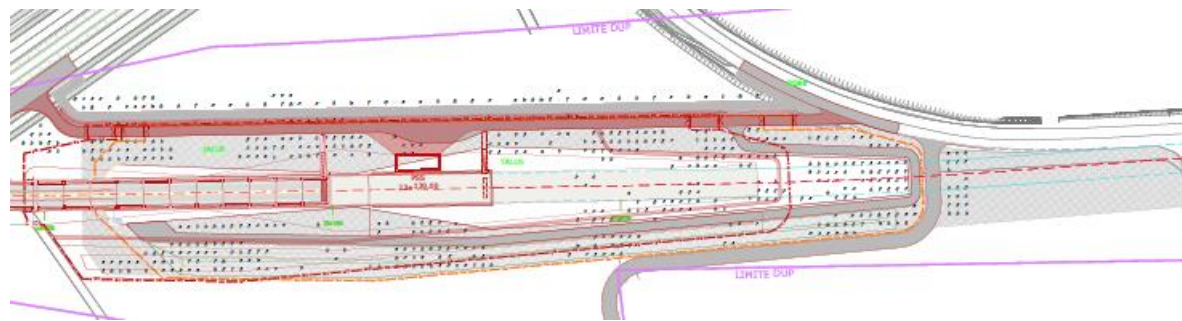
Vue en plan de l'ouvrage en terre de Tremblay-en-France (sur la gauche du plan)
